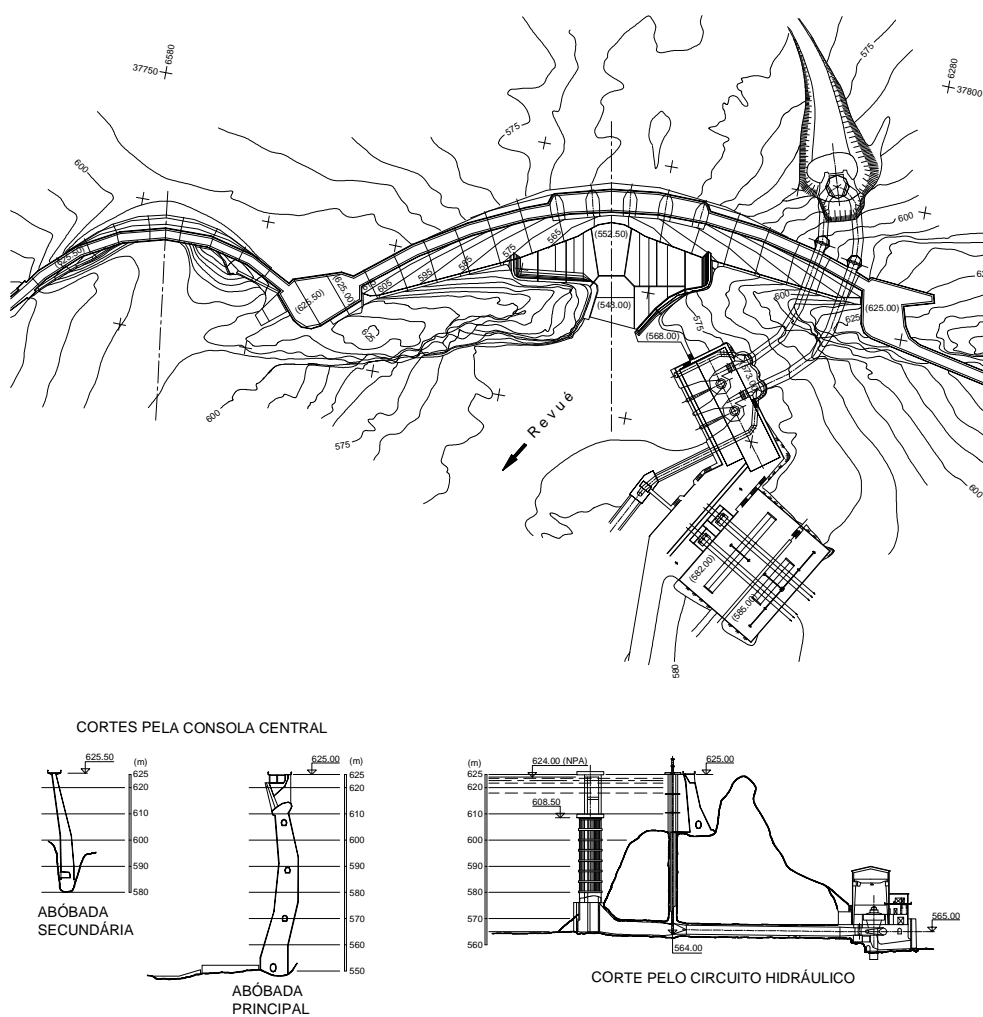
Barragem da Chicamba. Planta e cortes (fonte: LNEC)
